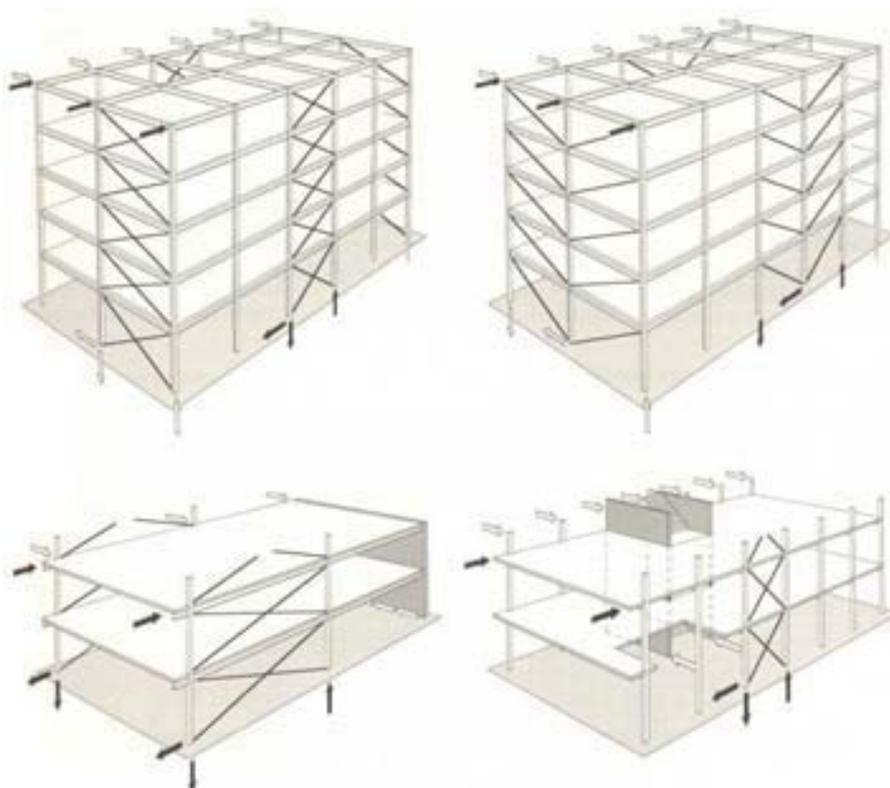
Esquema de funcionamento do contraventamento vertical para edifícios baixos
